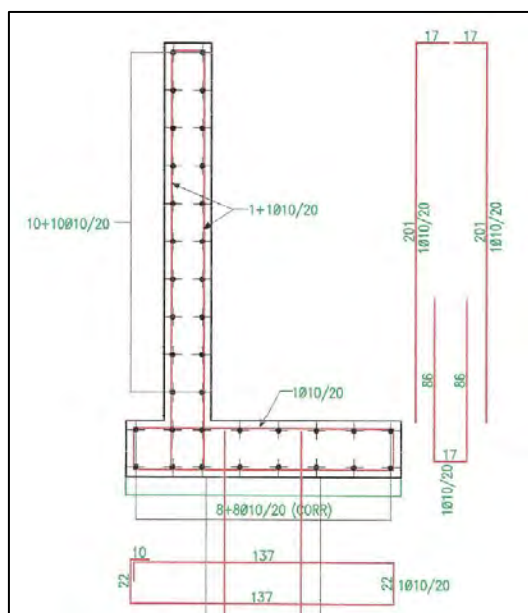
Armatura del muro esistente tratta dal progetto 2010
